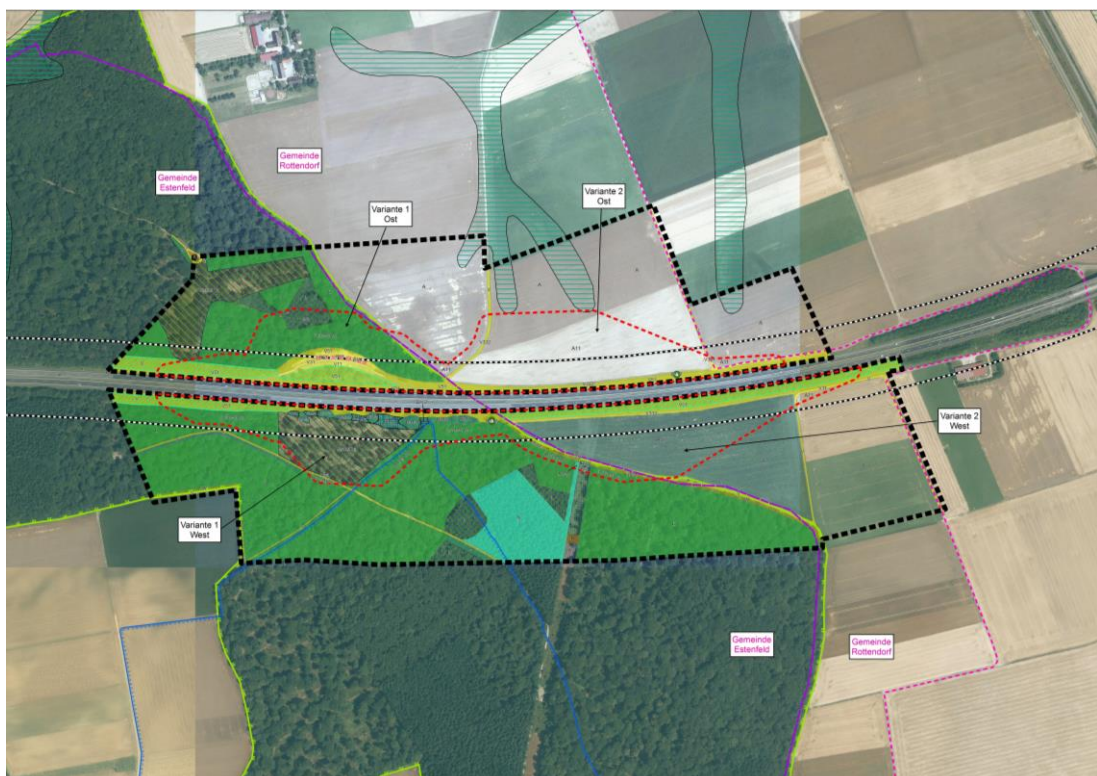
Übersicht Standortvarianten PWC-Anlage; Ausschnitt aus "Plan 1: Bestandsplan LBP zu den Standortvarianten", erstellt durch Planungsgruppe Landschaft, Datum 2017/2018
